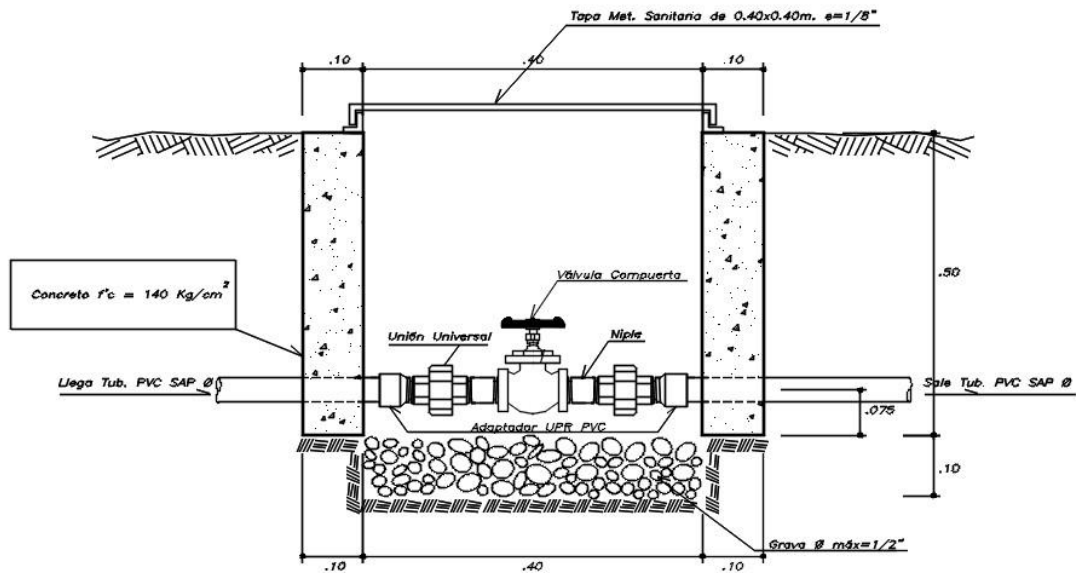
Detalles vista de corte transversal de Válvula de Purga Tipo I (CAD)
